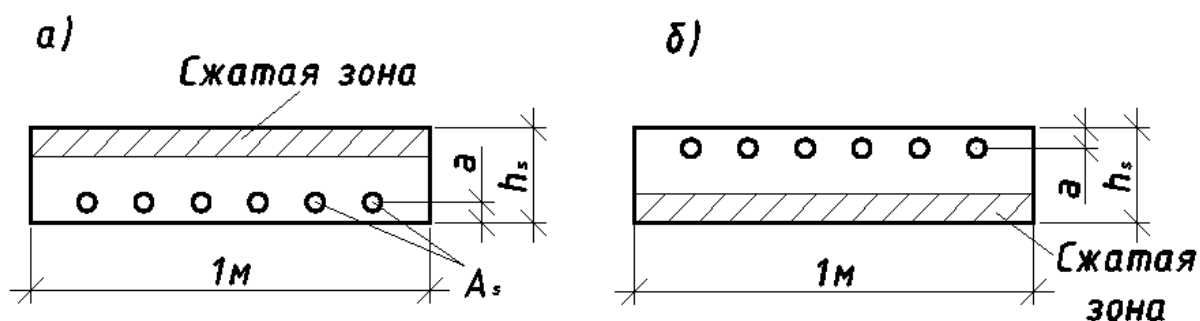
Расчетные сечения плиты: а – в пролете; б – на опоре
